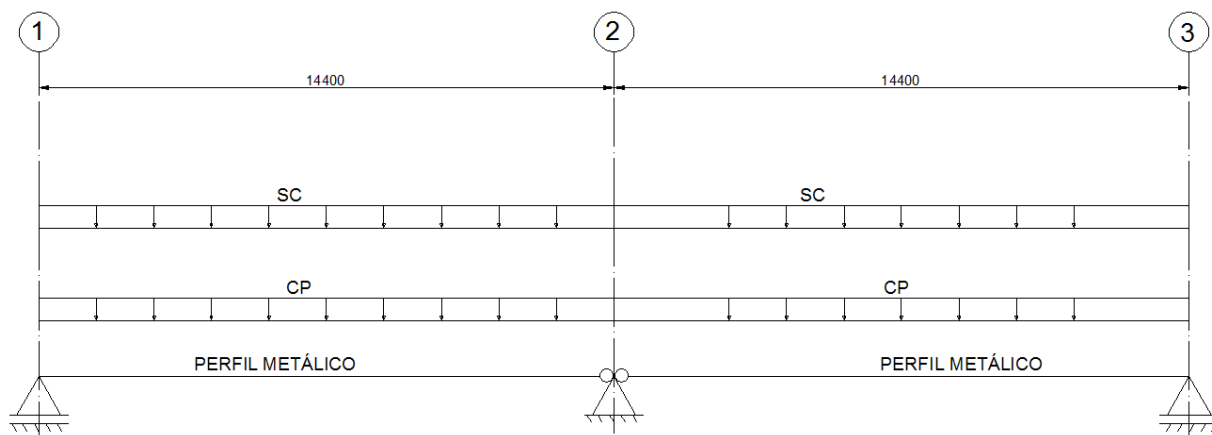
Distribuição de cargas adotada – Estrutura metálica convencional
